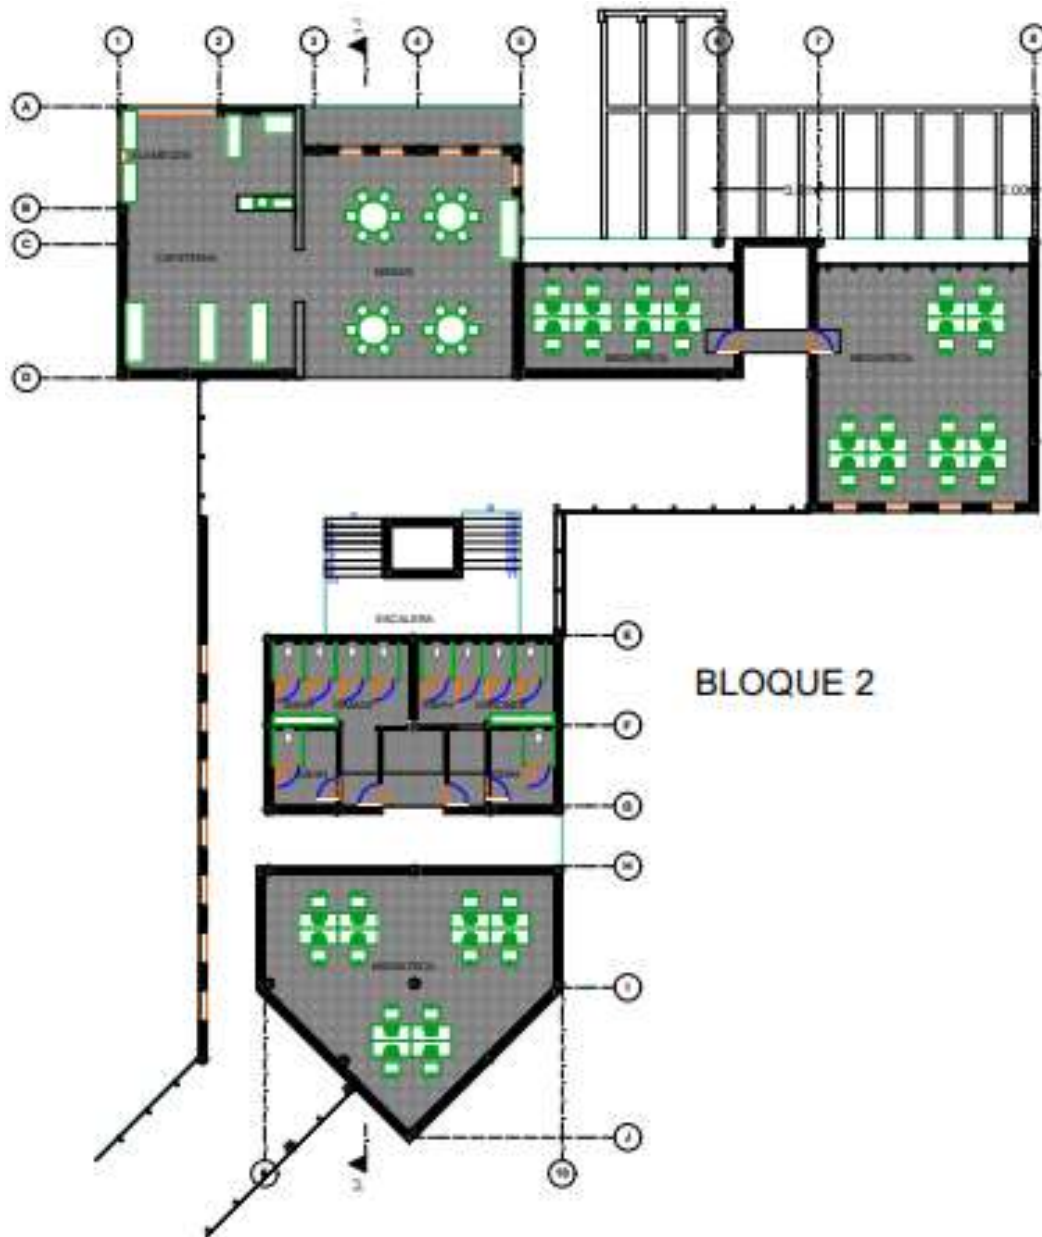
Plano en planta Segundo Nivel – Bloque 2
